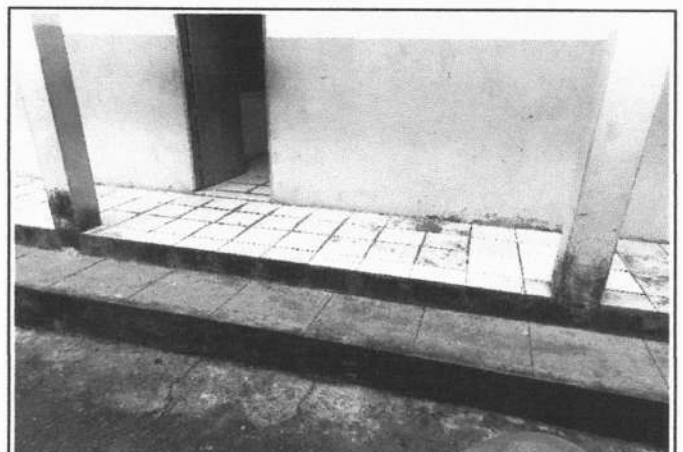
SUBSTITUIÇÃO DE PISOS
